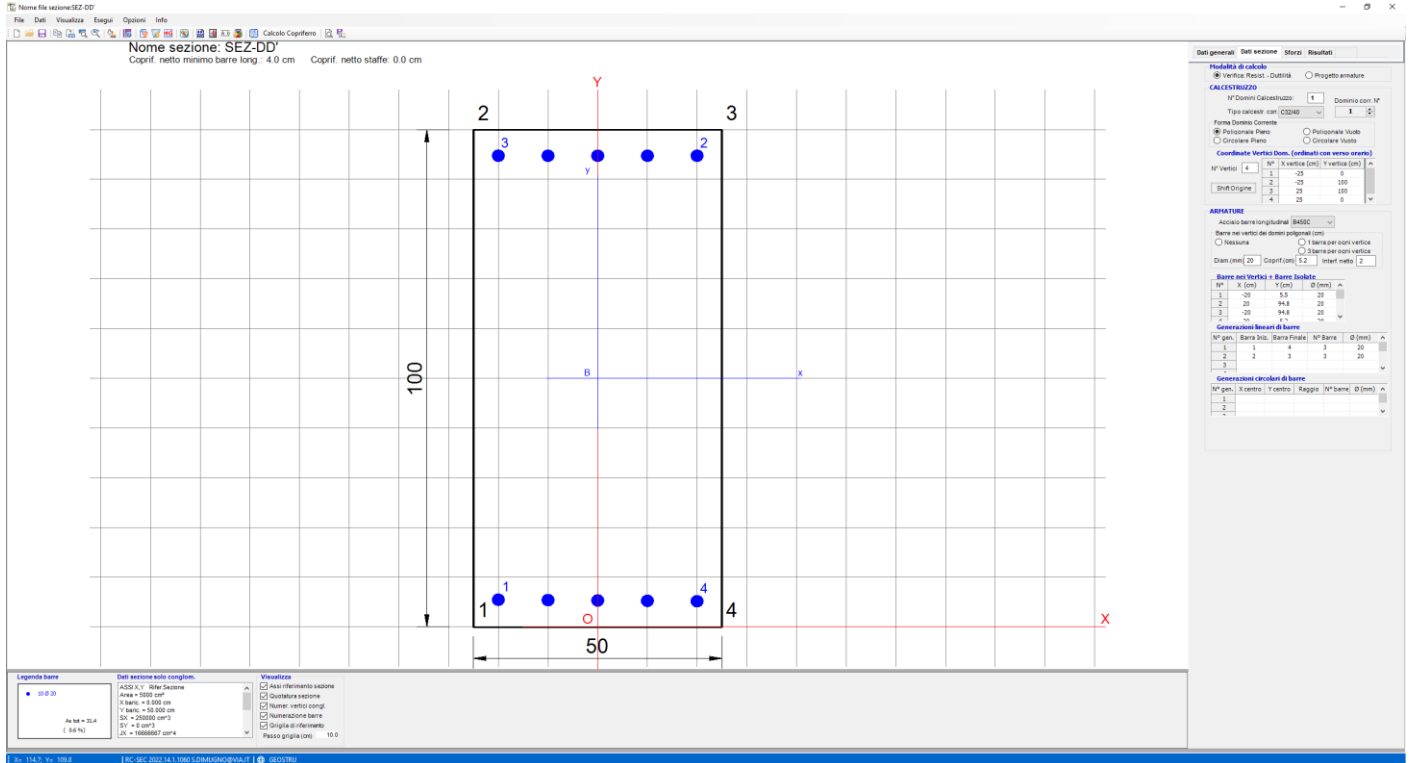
Paraghaia - Geometria sezione di verifica
